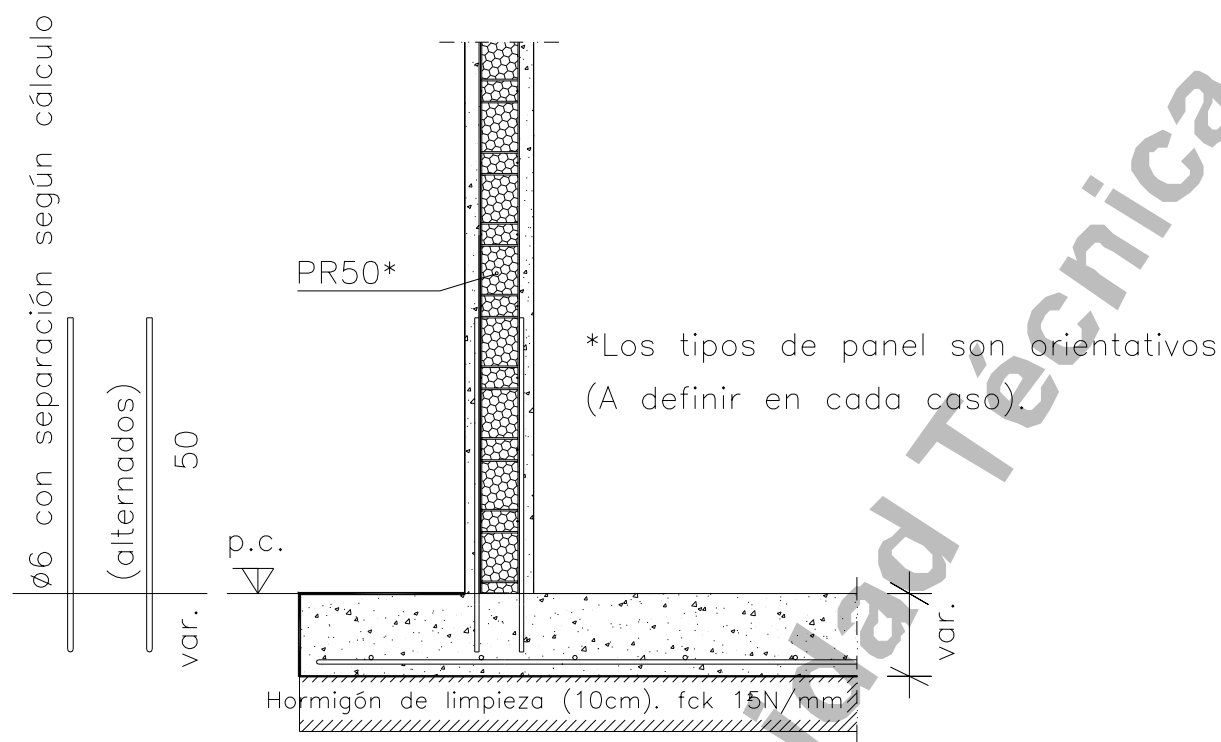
Detalle de unión de paneles a cimentación con armadura única
